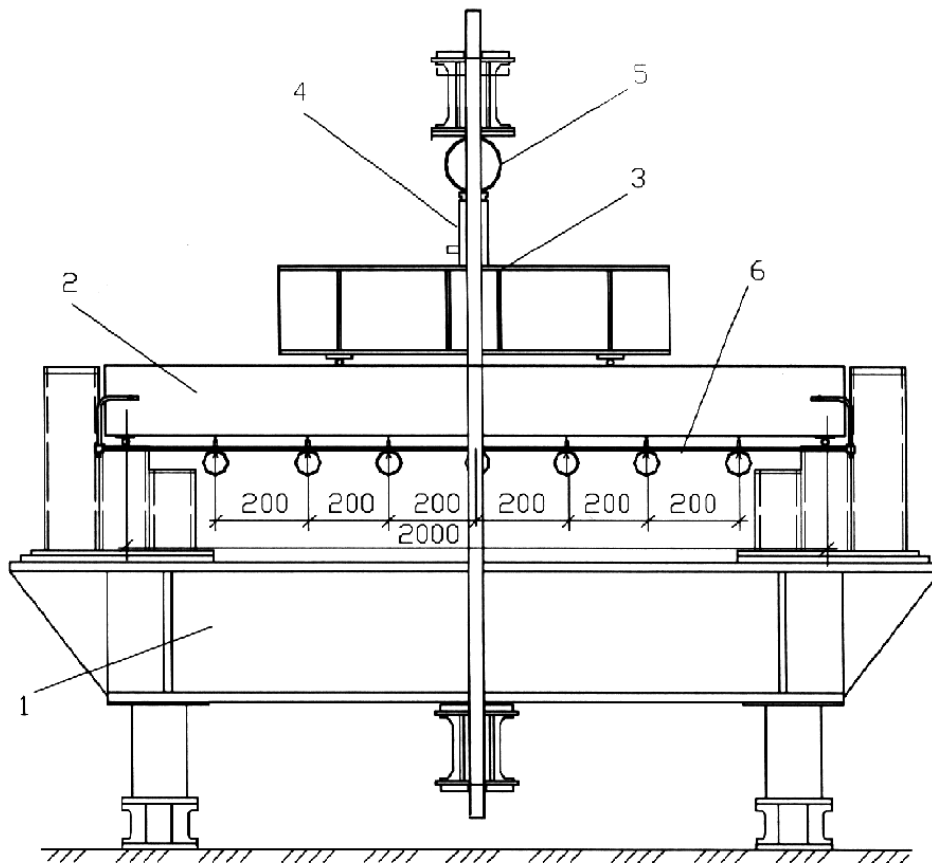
Схема випробування залізобетонної балки на силовому стенді:
